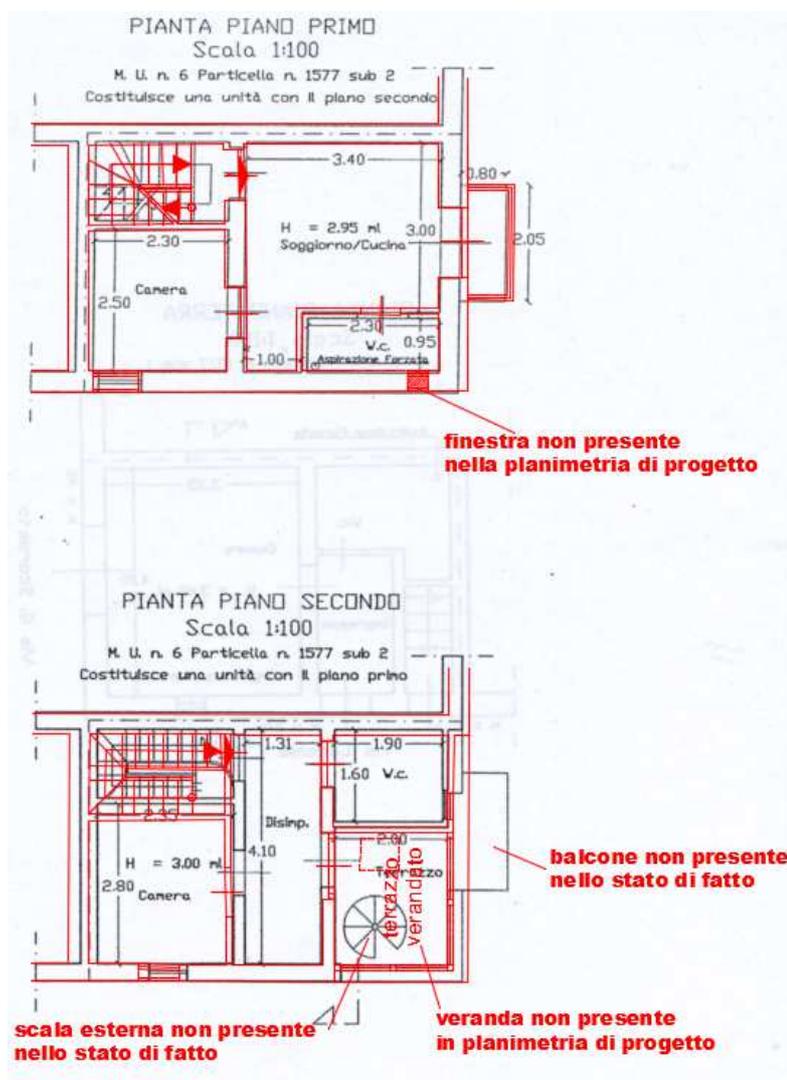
Sovrapposizione delle planimetrie di rilievo con le planimetrie di progetto
